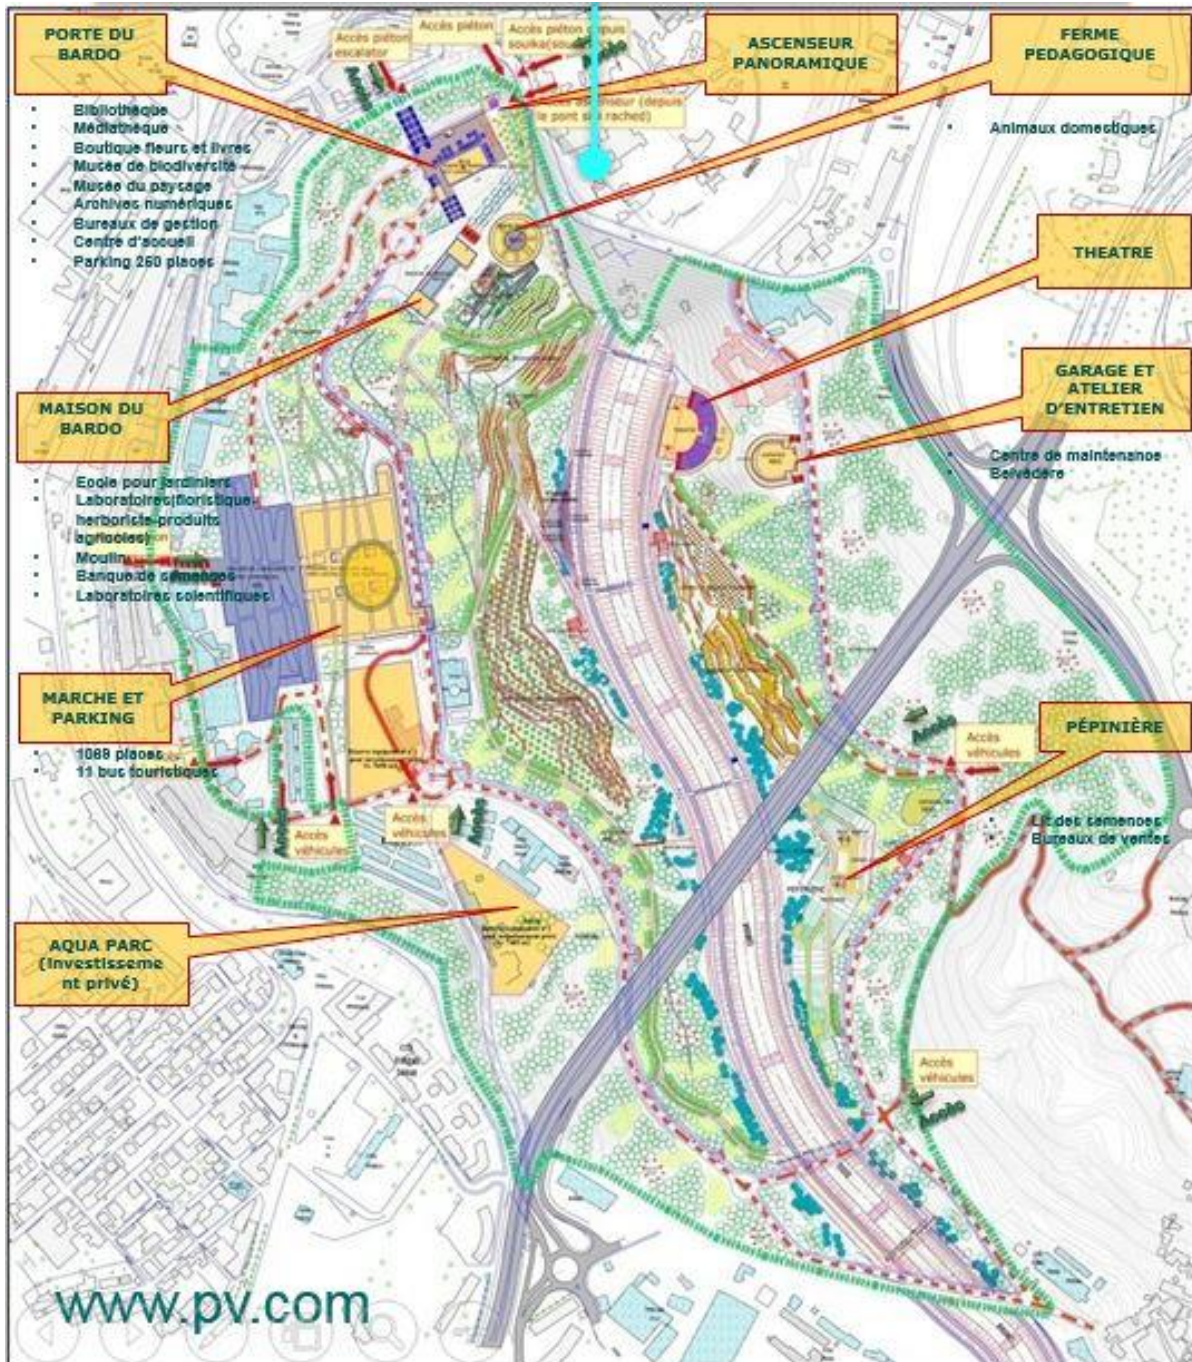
plan d'aménagement de parc de Bardo 2014 [19]
